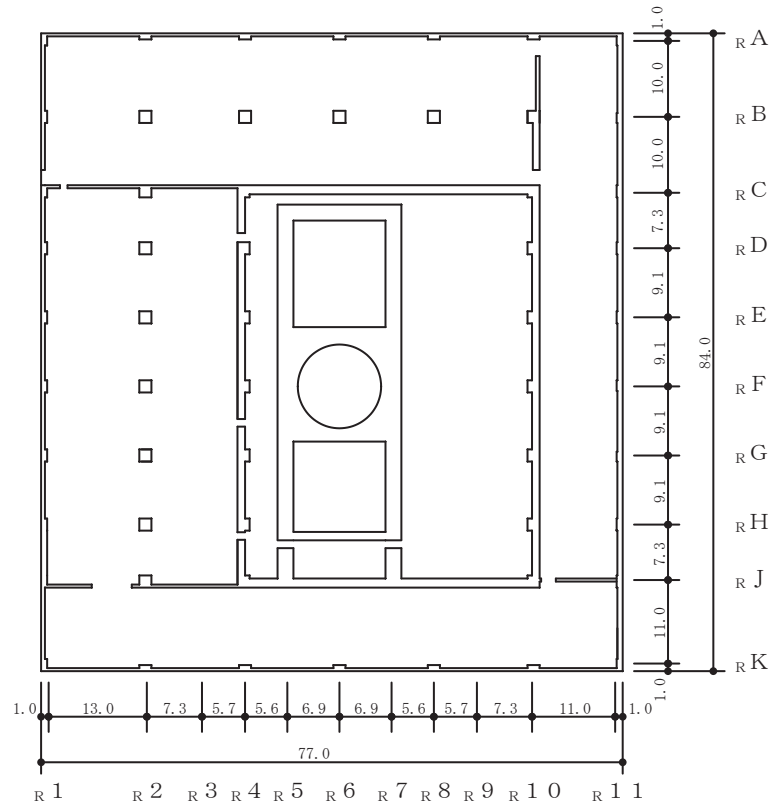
(3) 原子炉建屋の概略平面図 (O.P. 6.0m)
